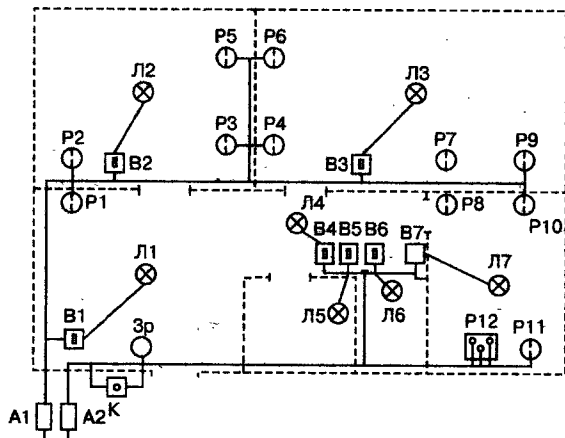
Примерный план электропроводки с нанесенными на нее электроконструкциями и электроустановочными приборами
